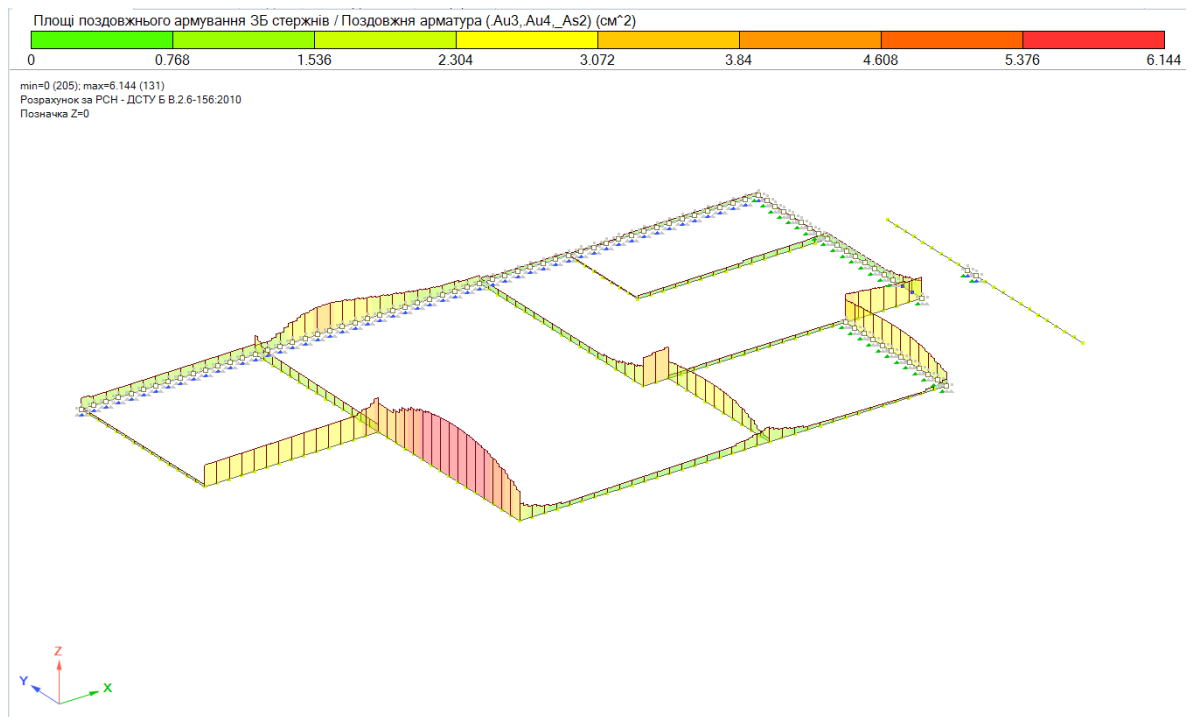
Епюри необхідної площі нижньої поздовжньої арматури As2
